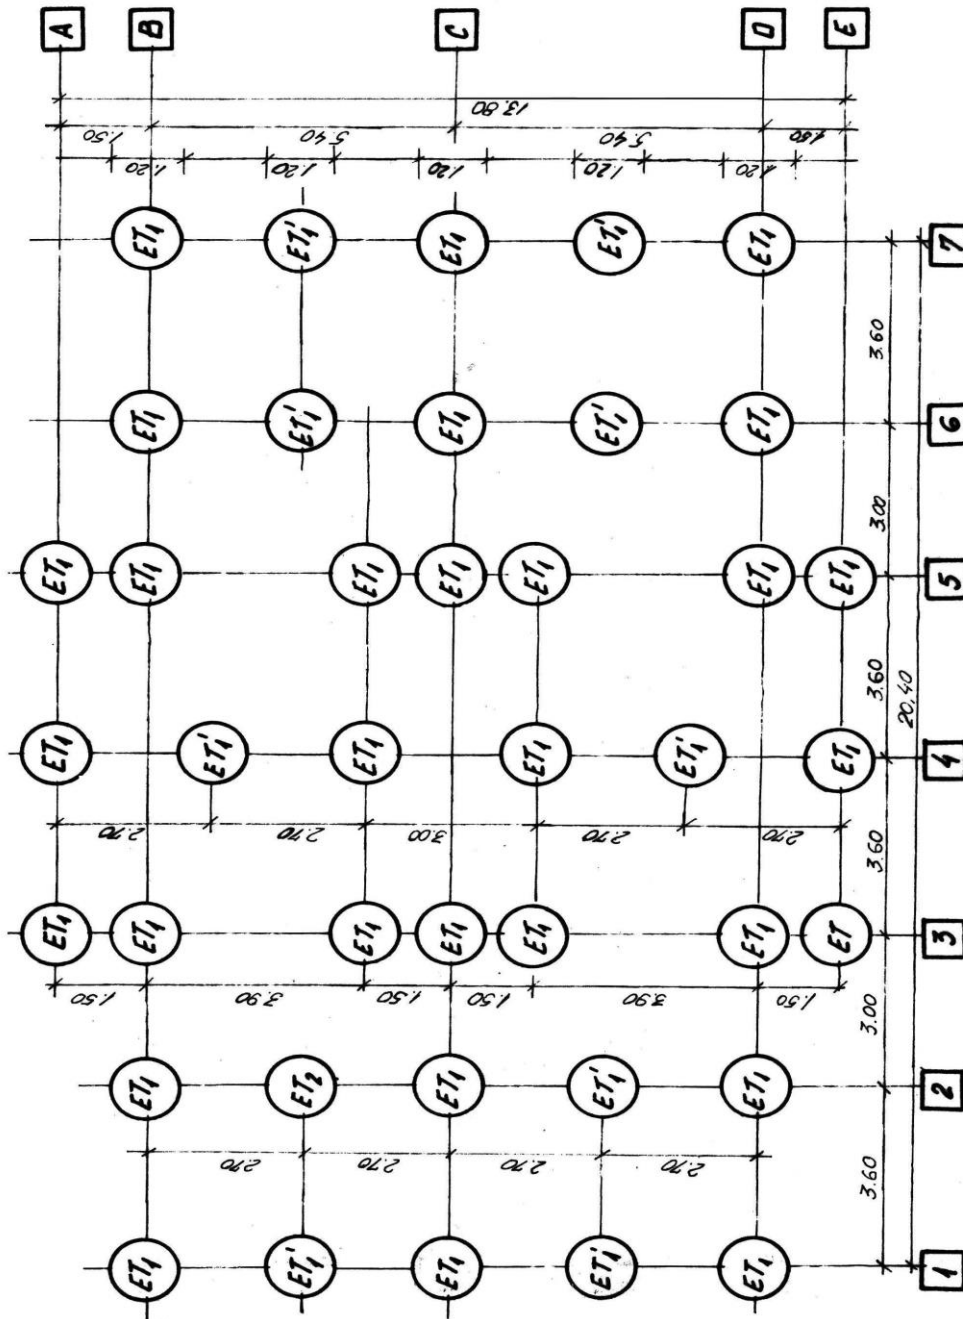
Plan de amplasare a elementelor pe talpă.
